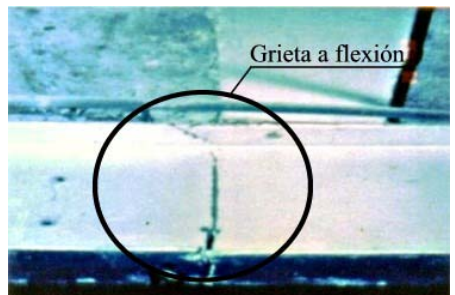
Falla a flexión en viga transversal de puente de armadura. Puente Regional Risaralda.
